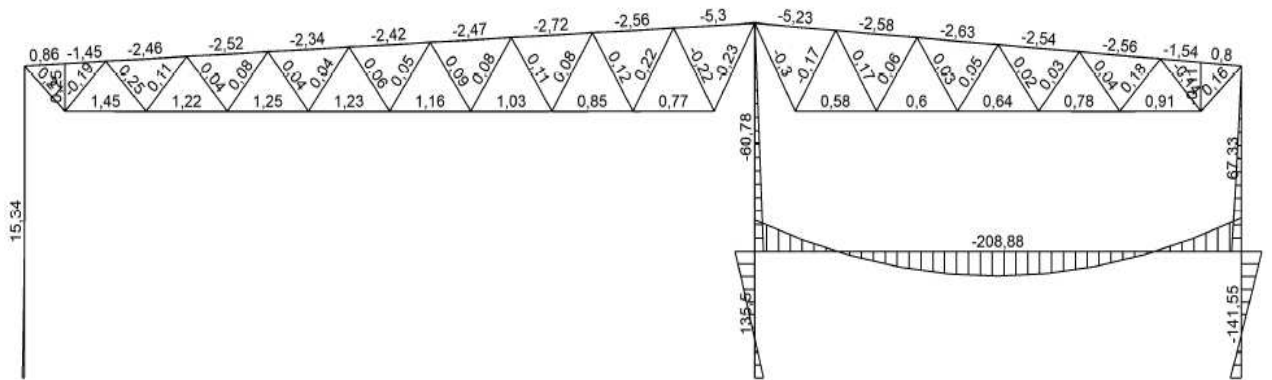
Эпюры изгибающих моментов M (кНм) от расчетного сочетания нагрузок
